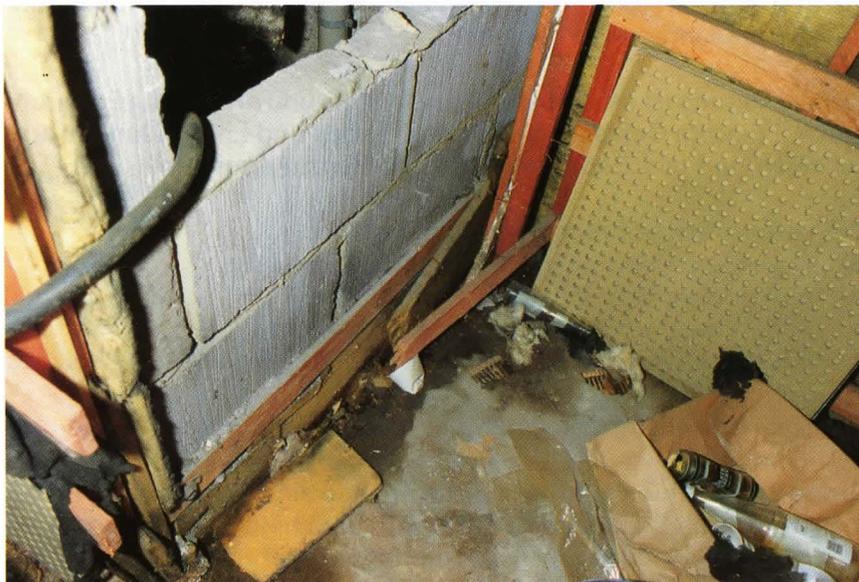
Wassereintritt über Estrich und Abmauerung des Installationsschachtes
